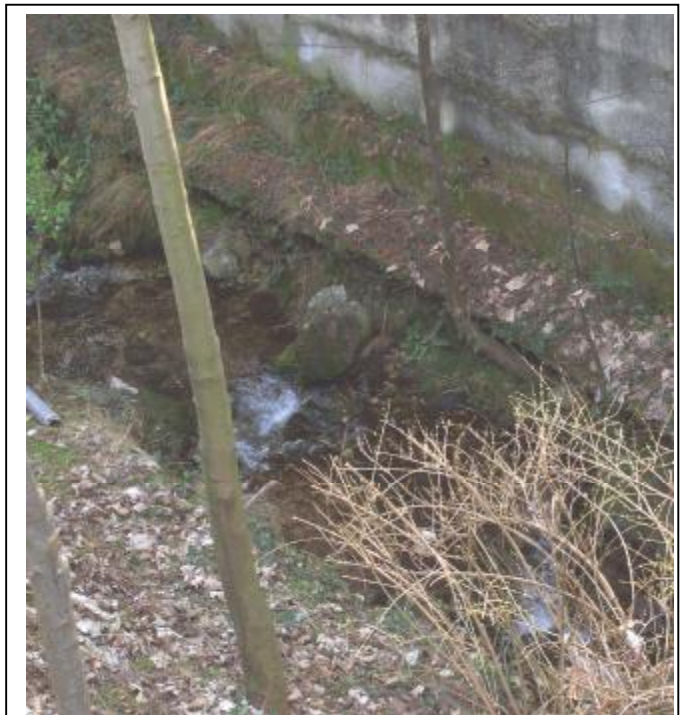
Particolare del fenomeno di erosione al piede in sponda destra, a valle dell'attraversamento
